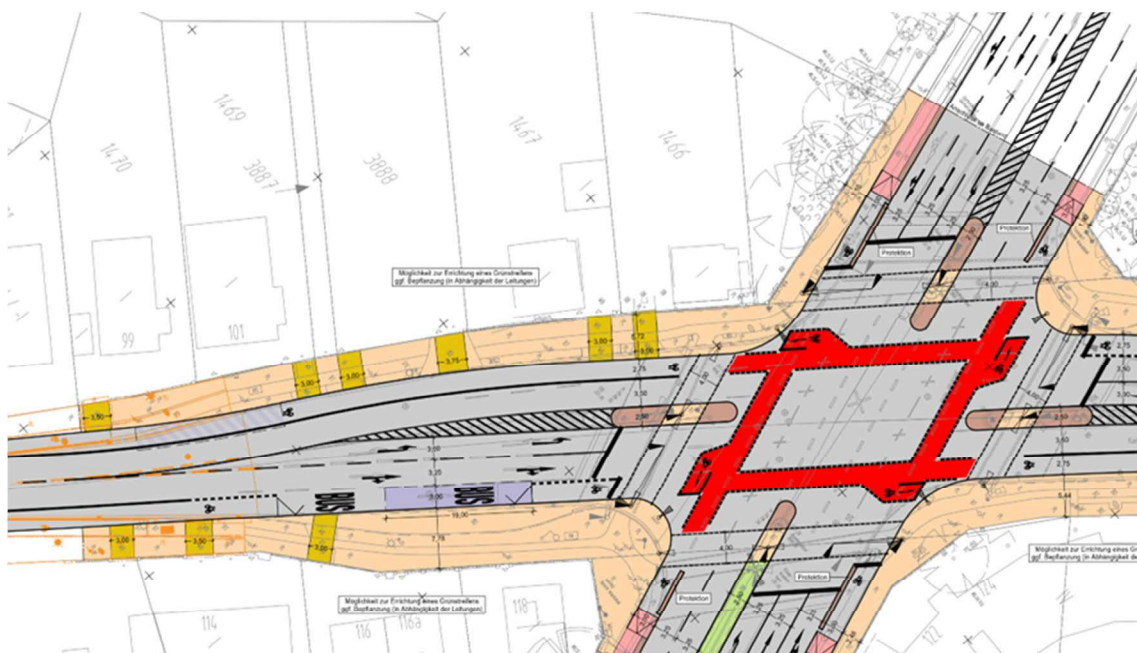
Lageplan Variante 2 (Ausschnitt)
